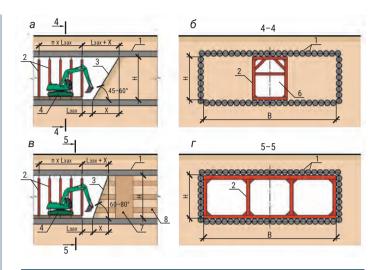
Схемы разработки грунта под защитой экрана из труб:
